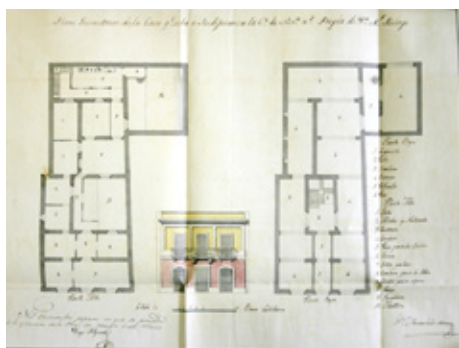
Planta y alzado de la Casa-Bodega de Manuel Viergol. AMEPSM.
